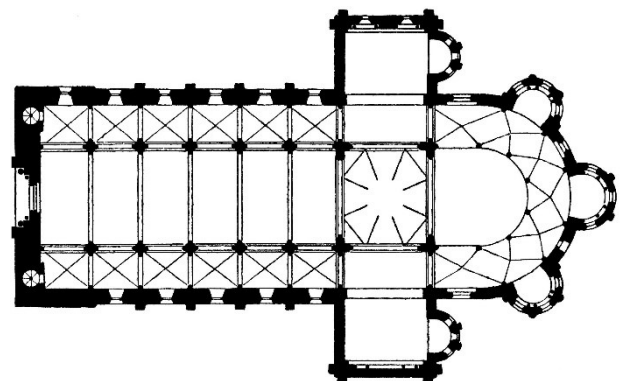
Grundriss von S.Etienne in Nevers
